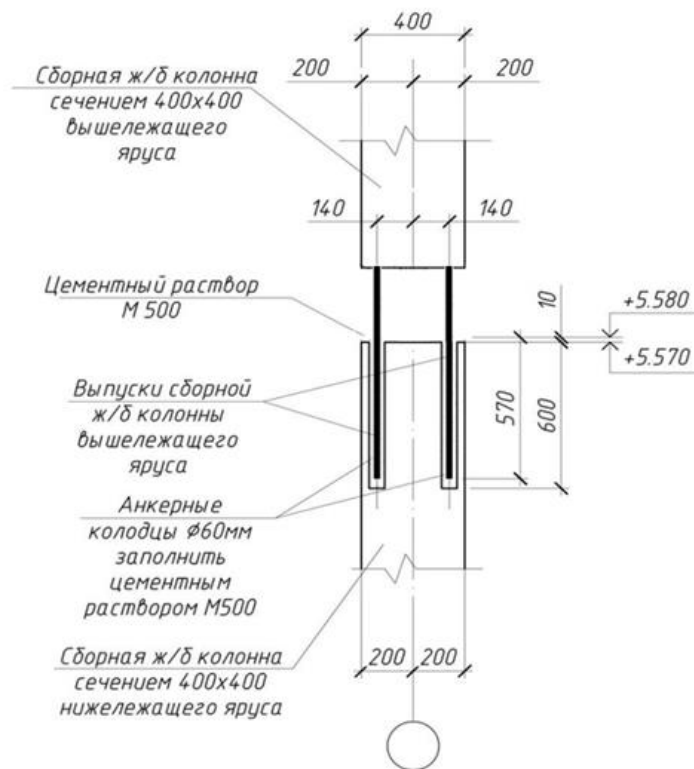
Узел сопряжения колонн каркаса – штепсельный стык
